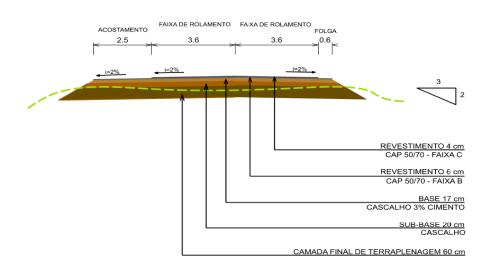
Estrutura do Pavimento / Duplicação da DF-140
